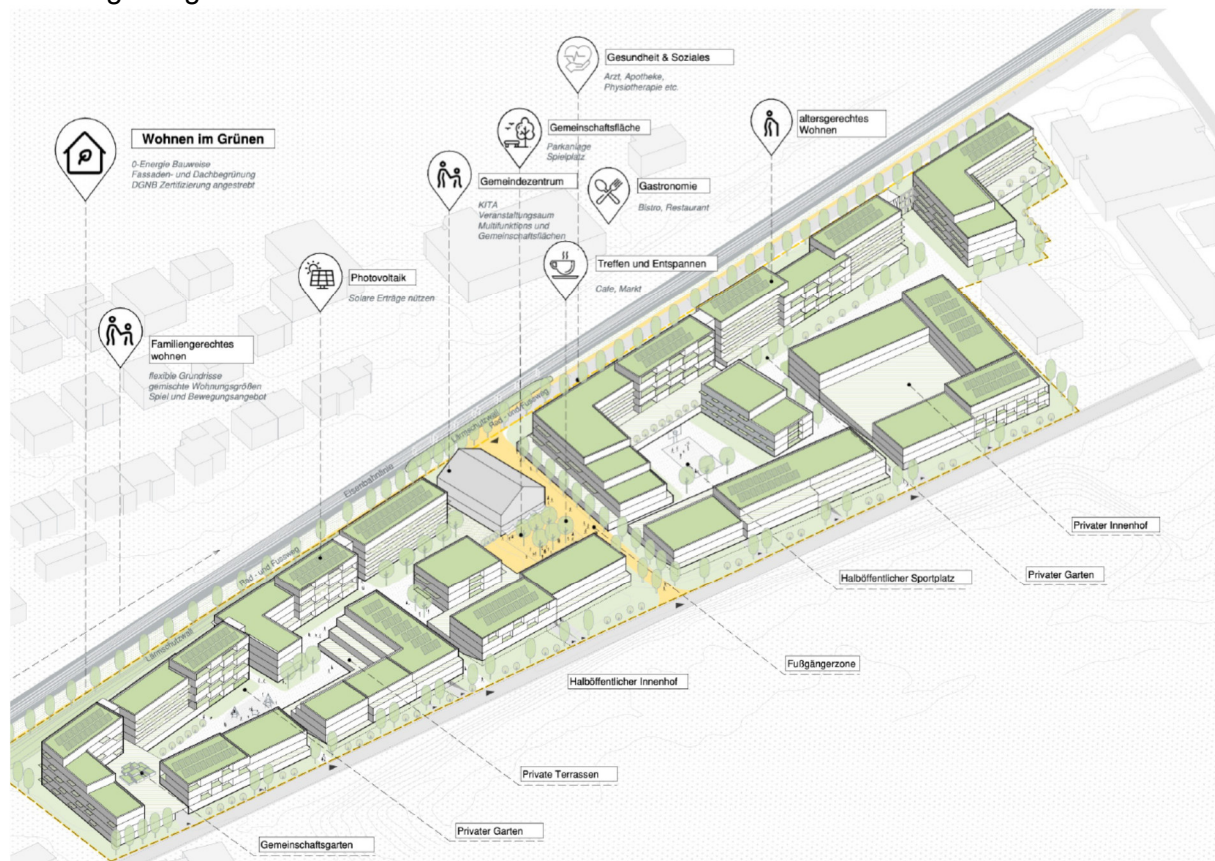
Aktuelle Planung für eine verdichtete Wohnbebauung mit Kleingewerbe (Quelle: vermehrt AG 2022)
